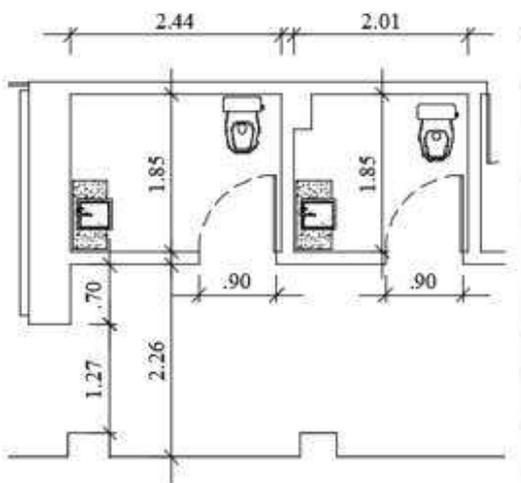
Banheiros do pavimento térreo do Morada das Artes com dimensões.
